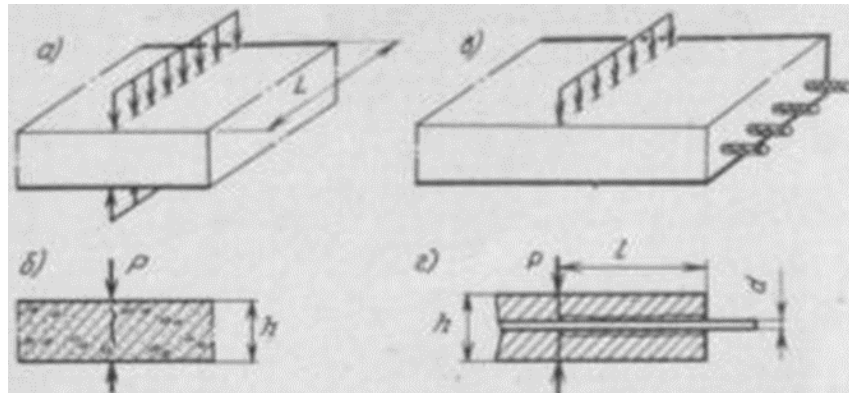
Схема завантаження бетонних і залізобетонних виробів під час руйнування
